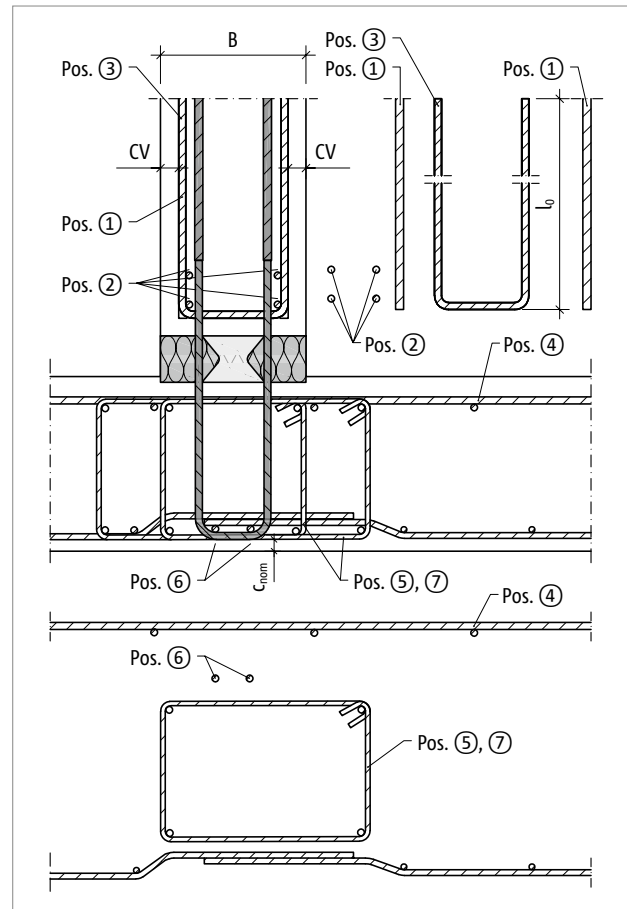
Schöck Sconnex® Typ W-NT-B: Bauseitige Bewehrung bei Zugkraftverankerung; deckengleicher Unterzug als Beispiel
